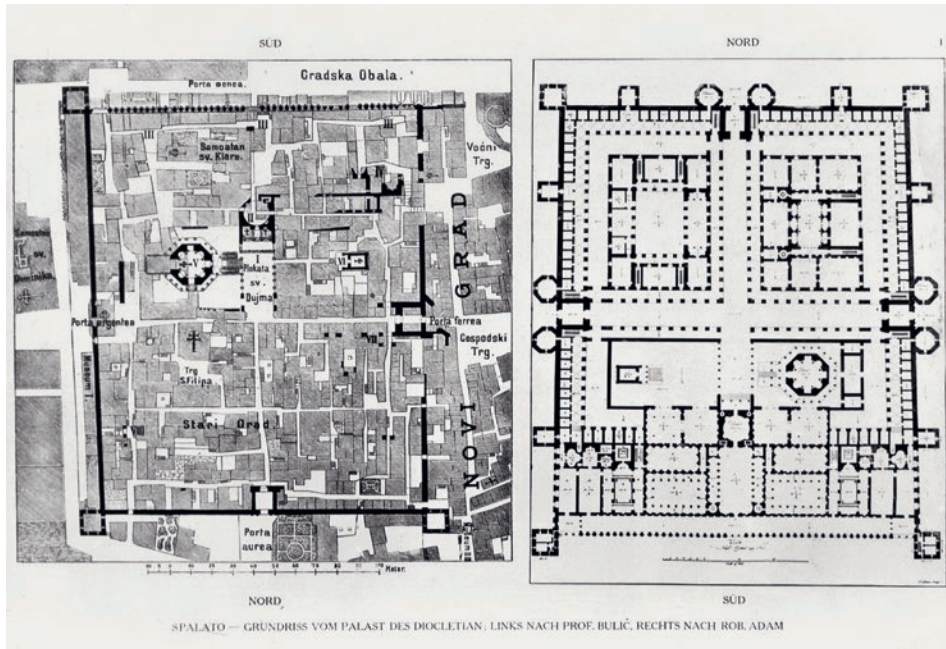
Spalato, Grundriss vom Palast des Diokletian
